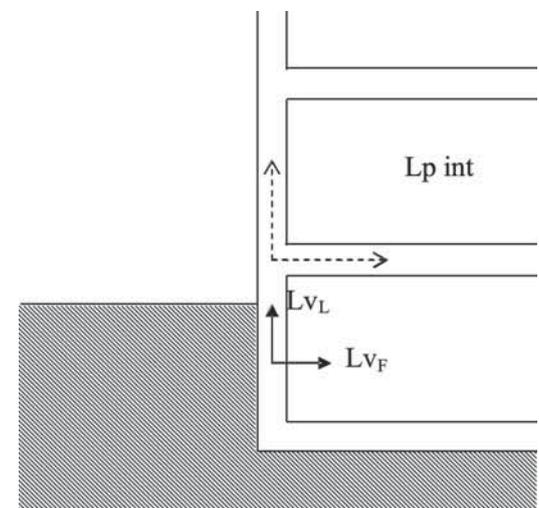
Coupe type d'un bâtiment avec un niveau de sous-sol ;
